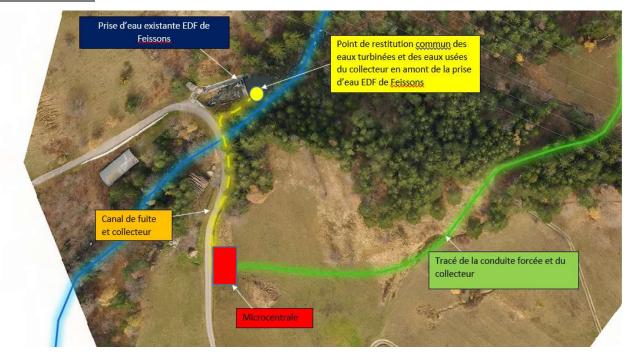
Mutualisation des travaux d'enfouissement de la conduite forcée et du collecteur d'eaux usées – Secteur aval
